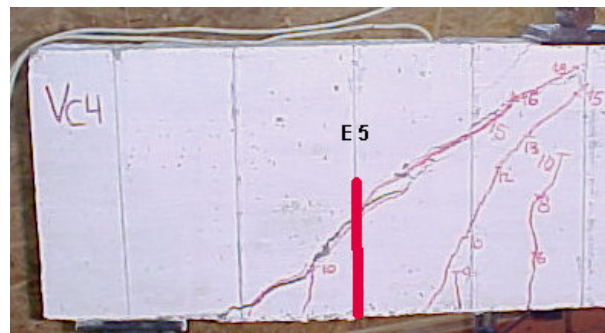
Detalhe da fissuração em E5 e posição dos extensômetros
